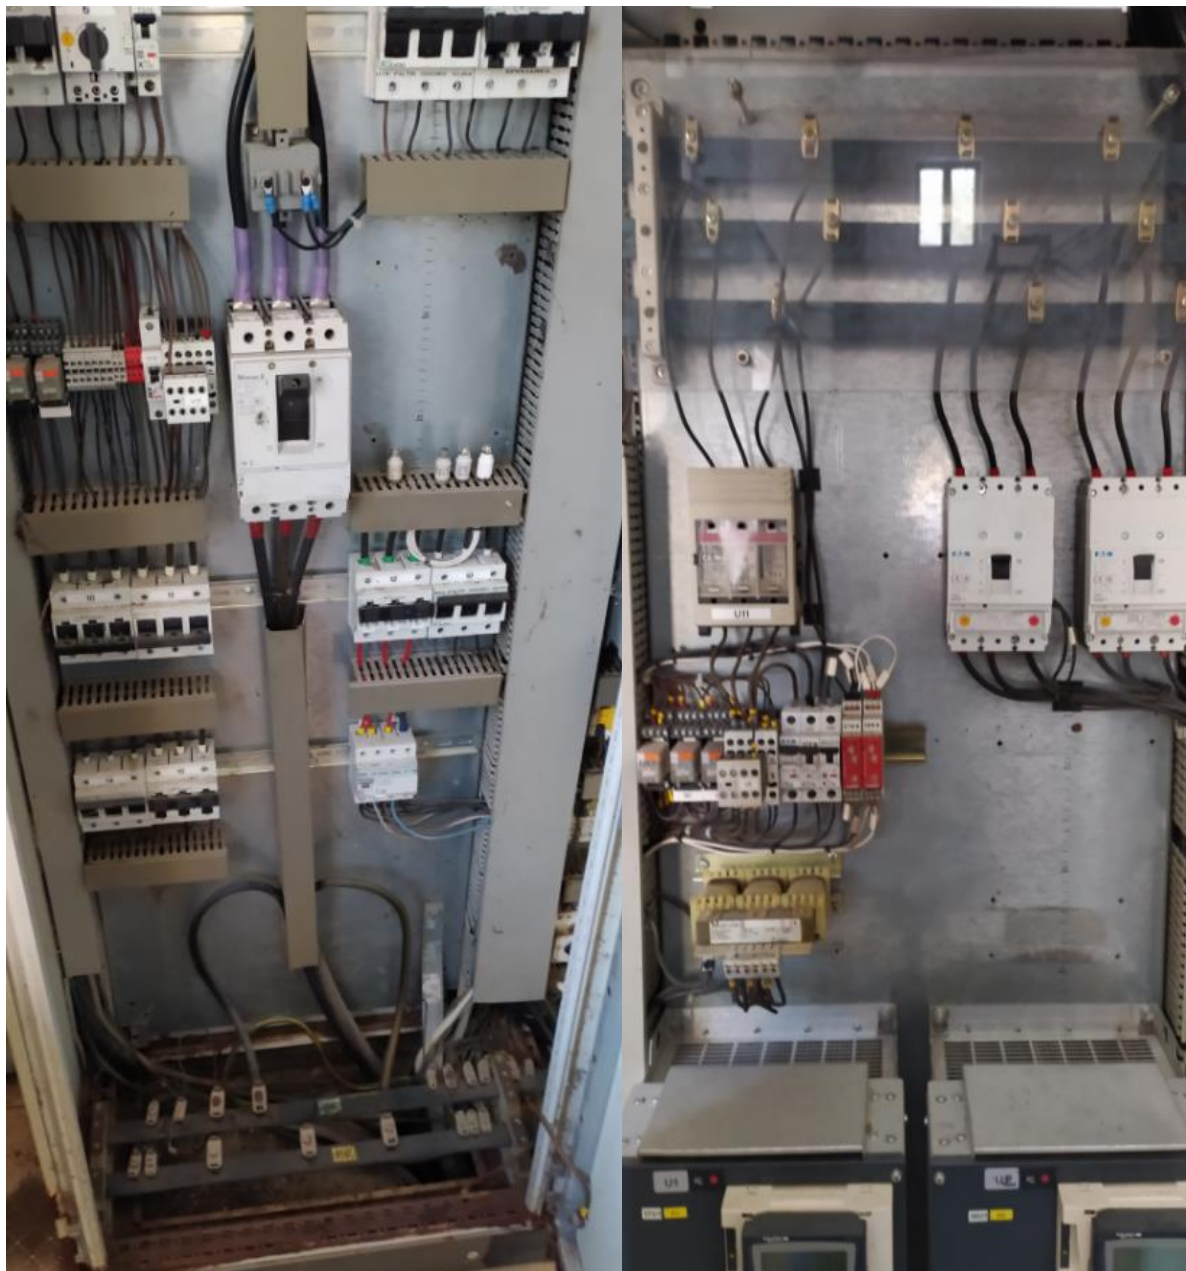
Widok wnętrza szafy PiA GS02 – płyta montażowa z zasilaczami oraz listwami przyłączeniowymi modułów I/O
